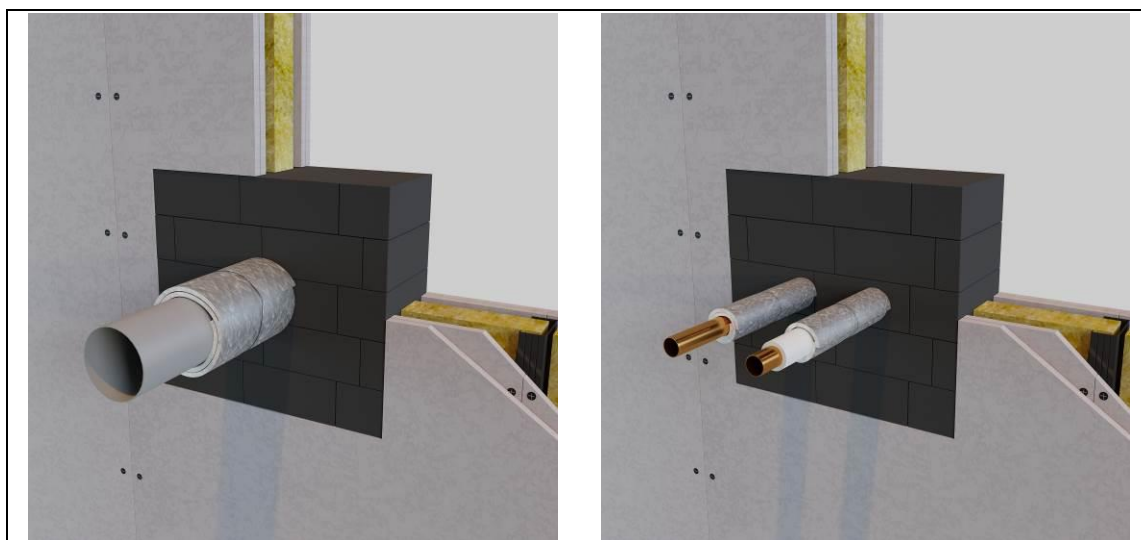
Esempi di sigillatura con AF BRICK di attraversamenti di tubazioni di acciaio protette in pareti flessibili.
